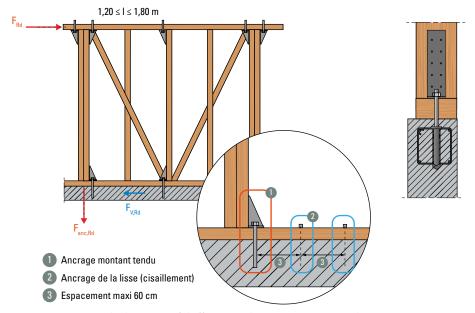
Exemple d'ancrages à l'effort tranchant et au moment de renversement
